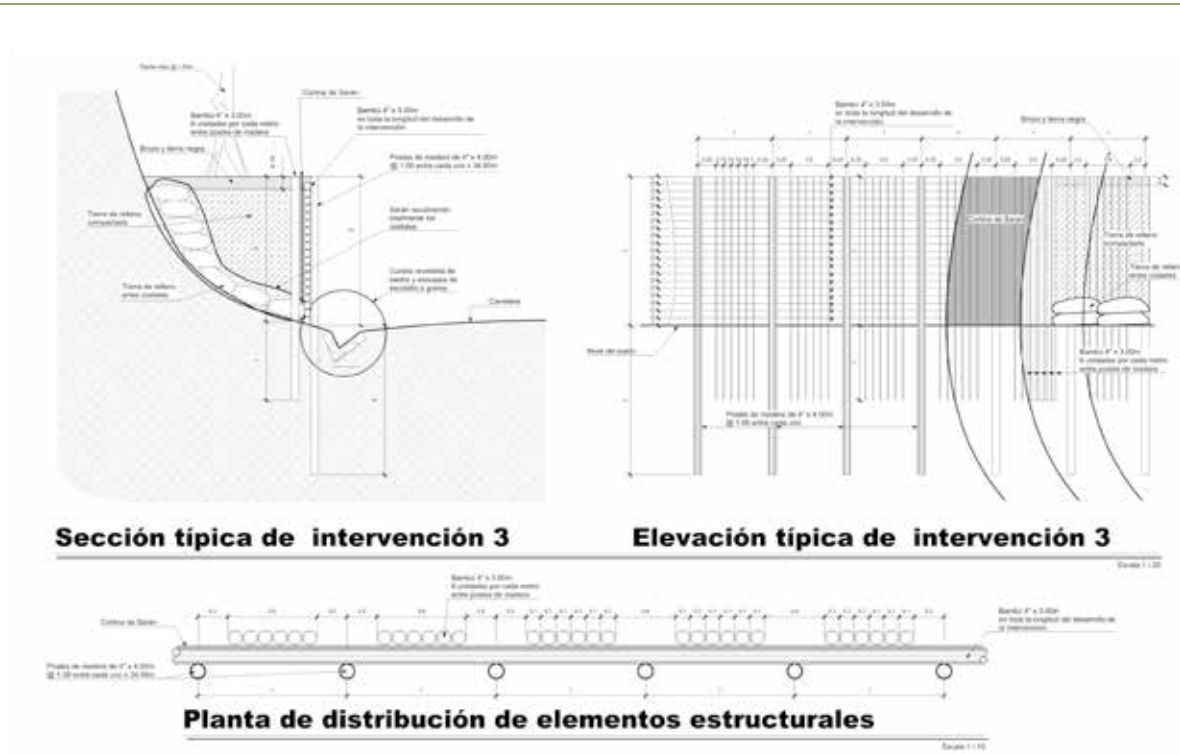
Sección típica intervención 3. Planificación Obra ORCC-02/RD-SOL-08.
